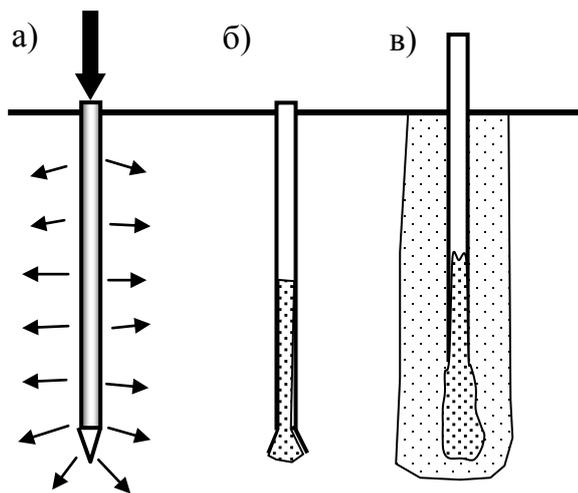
Метод глубинного уплотнения основания с использованием песчаных (грунтовых) свай: а – погружение трубы с раскрывающимся наконечником;
